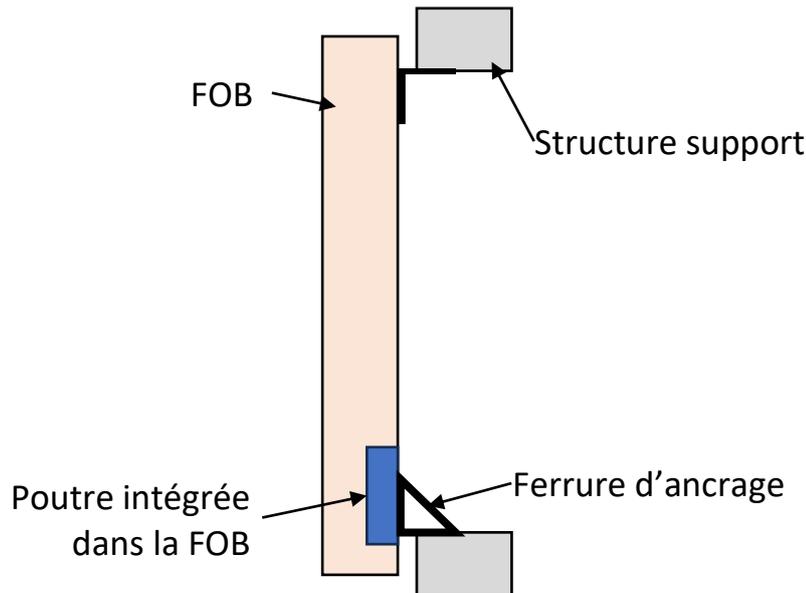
Principe de poutre intégrée à la FOB (Coupe verticale)
